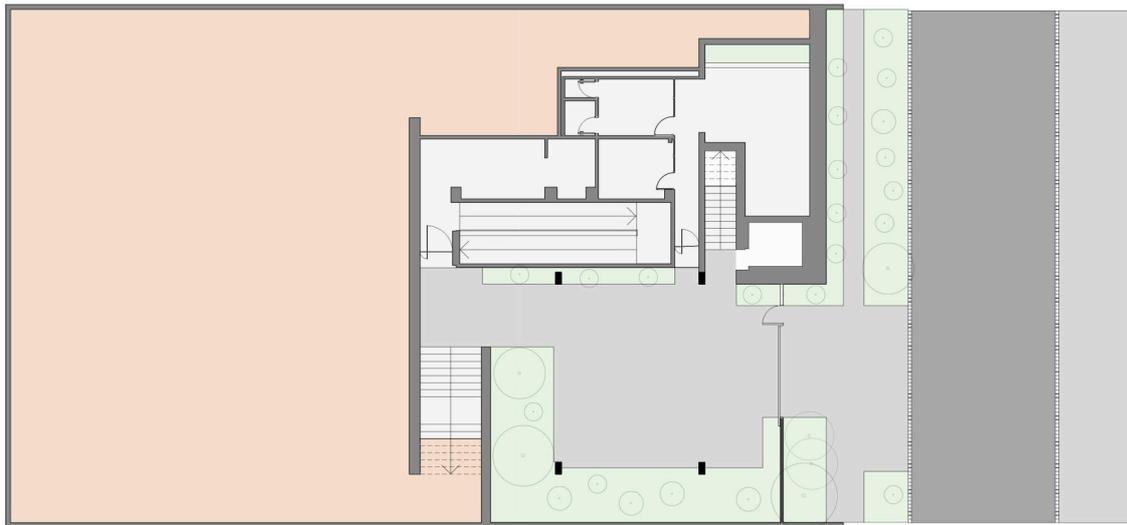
Casa Niclewicz, planta do 1º pavimento.
